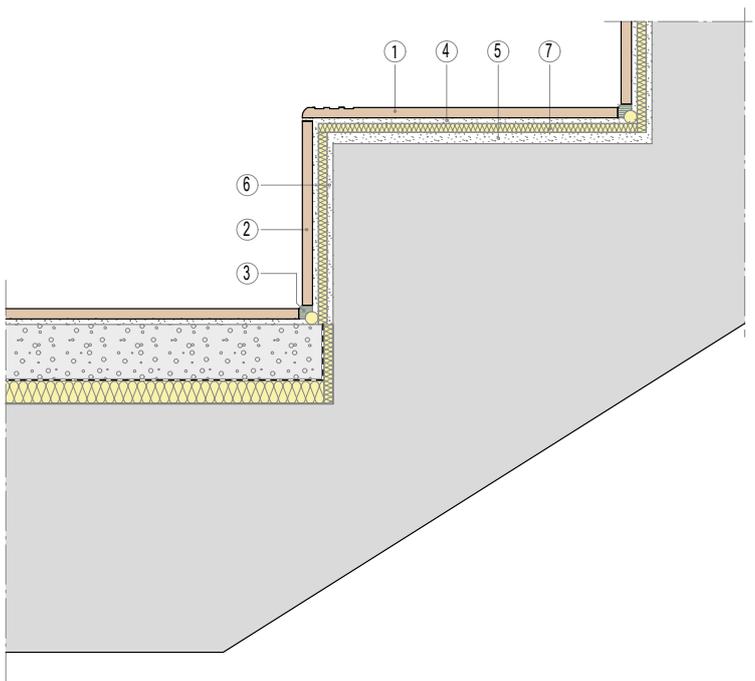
Ortbetonstufe mit trittschalldämmten Stufen
